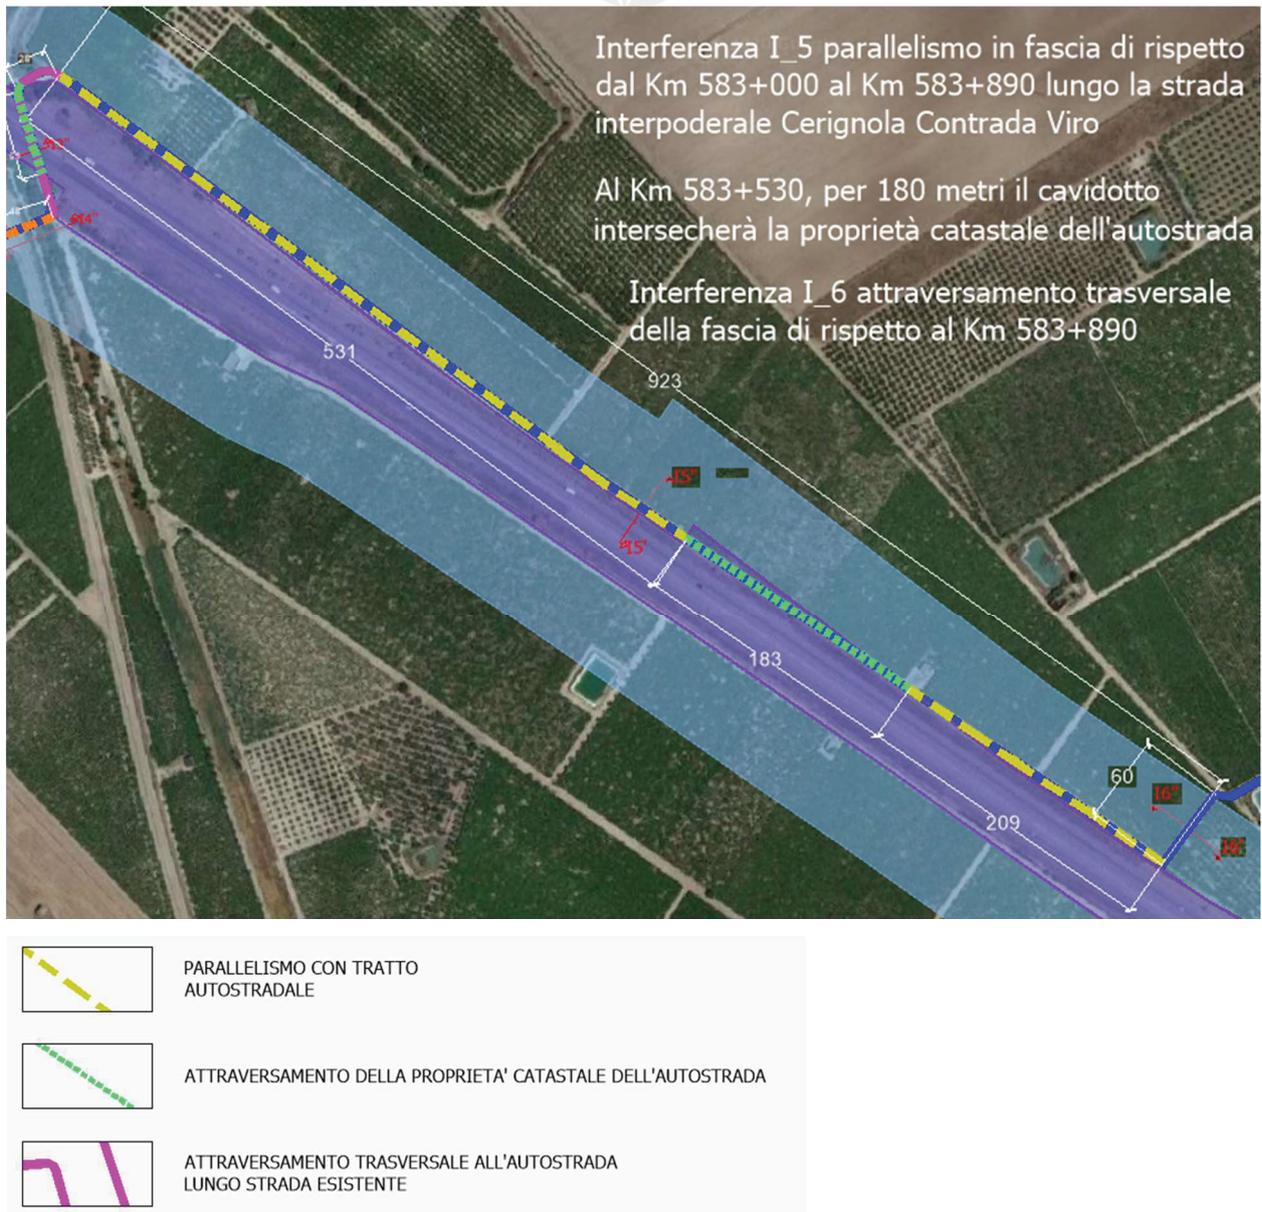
Interferenza I5 (parallelismo) e I6 (attraversamento trasversale dell'area di rispetto) dell'autostrada A14 su ortofoto
